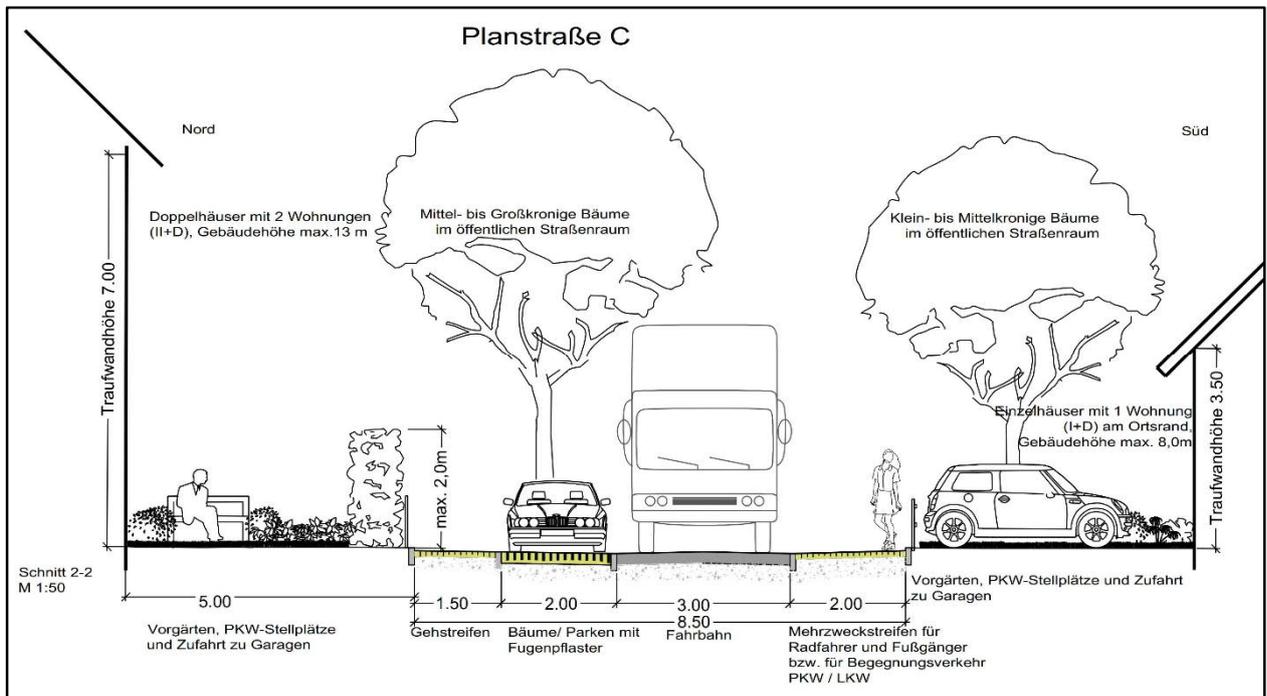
Straßenquerschnitt 8,5 m (Planstraße C)
